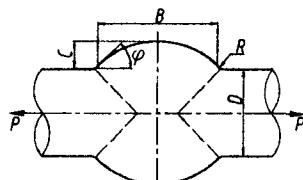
Расчетная схема стыкового соединения арматуры с усилением
